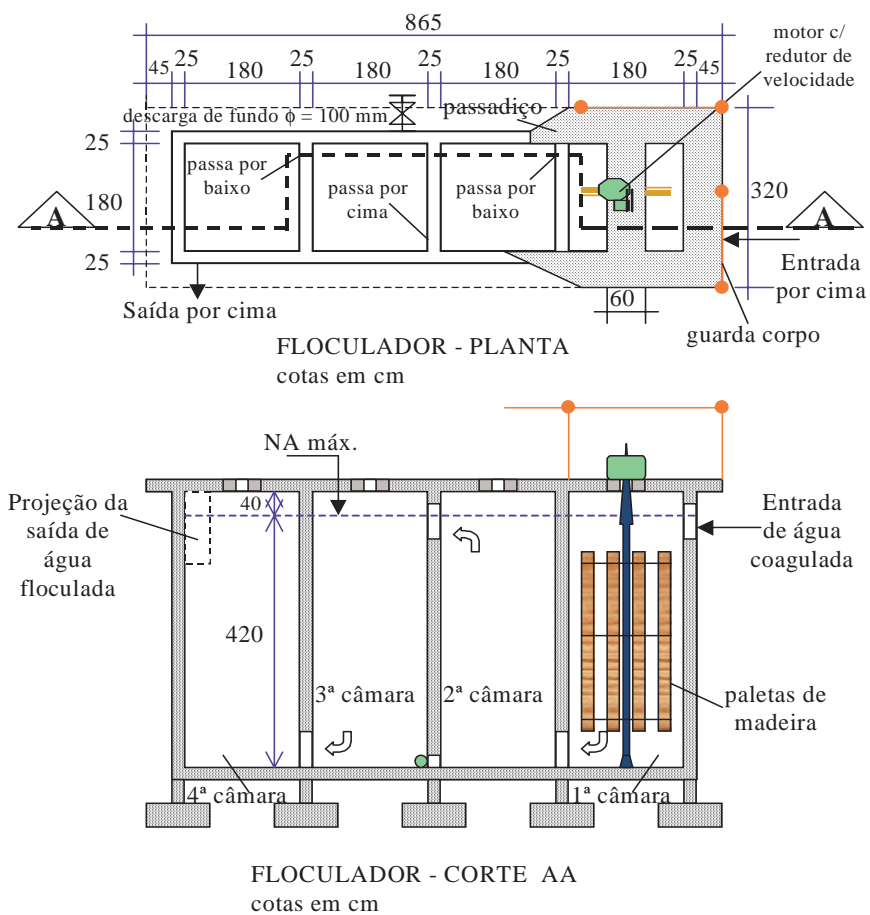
Planta e corte de um floclador mecânico com paletas verticais
